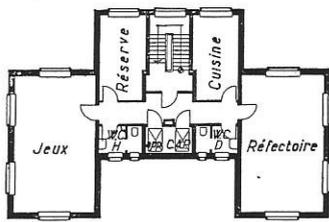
PLAN DU SIXIÈME ÉTAGE.
